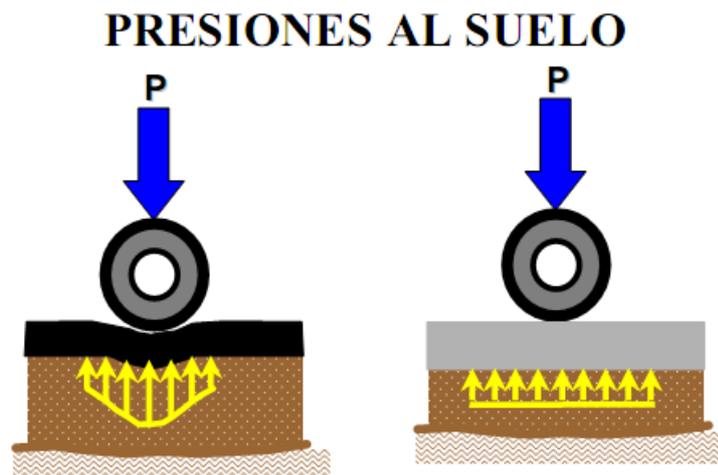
Distribución de presiones a las capas subyacentes del pavimento.
